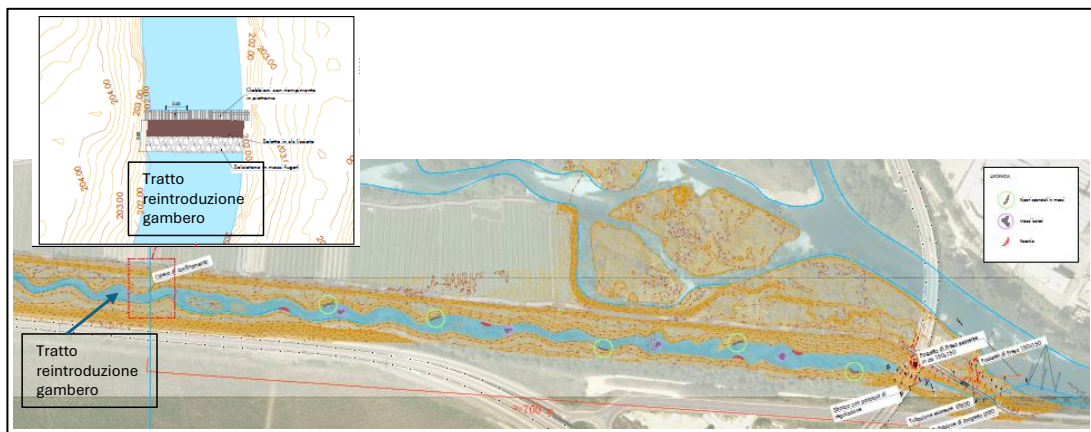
Planimetria progetto esecutivo Nocino. Nel riquadro: dettaglio opera di confinamento a valle del tratto ripristinato. Da planimetria progetto, fornito da SSAP-PAT.
